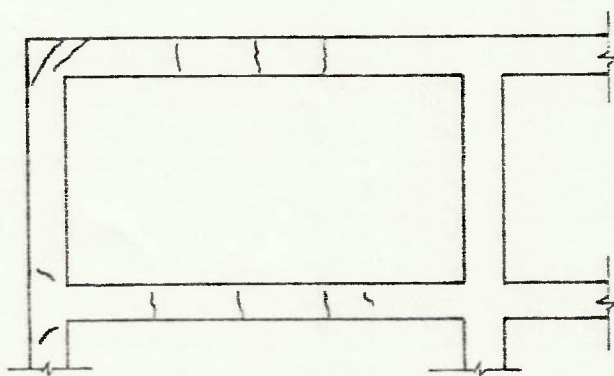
Trincas nas peças estruturais: a expansão da alvenaria solicita o concreto à tração
